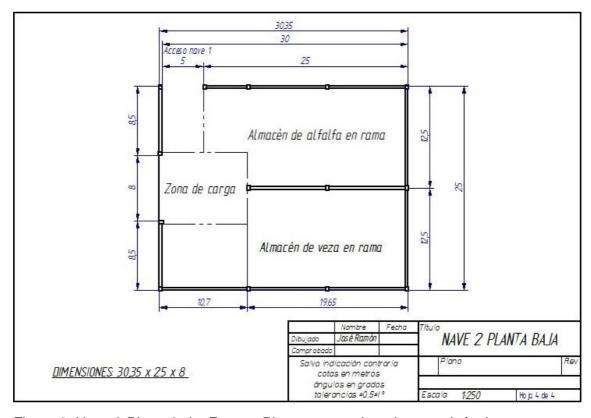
Nave 2-Planta baja. Fuente: Planos proporcionados por el técnico
